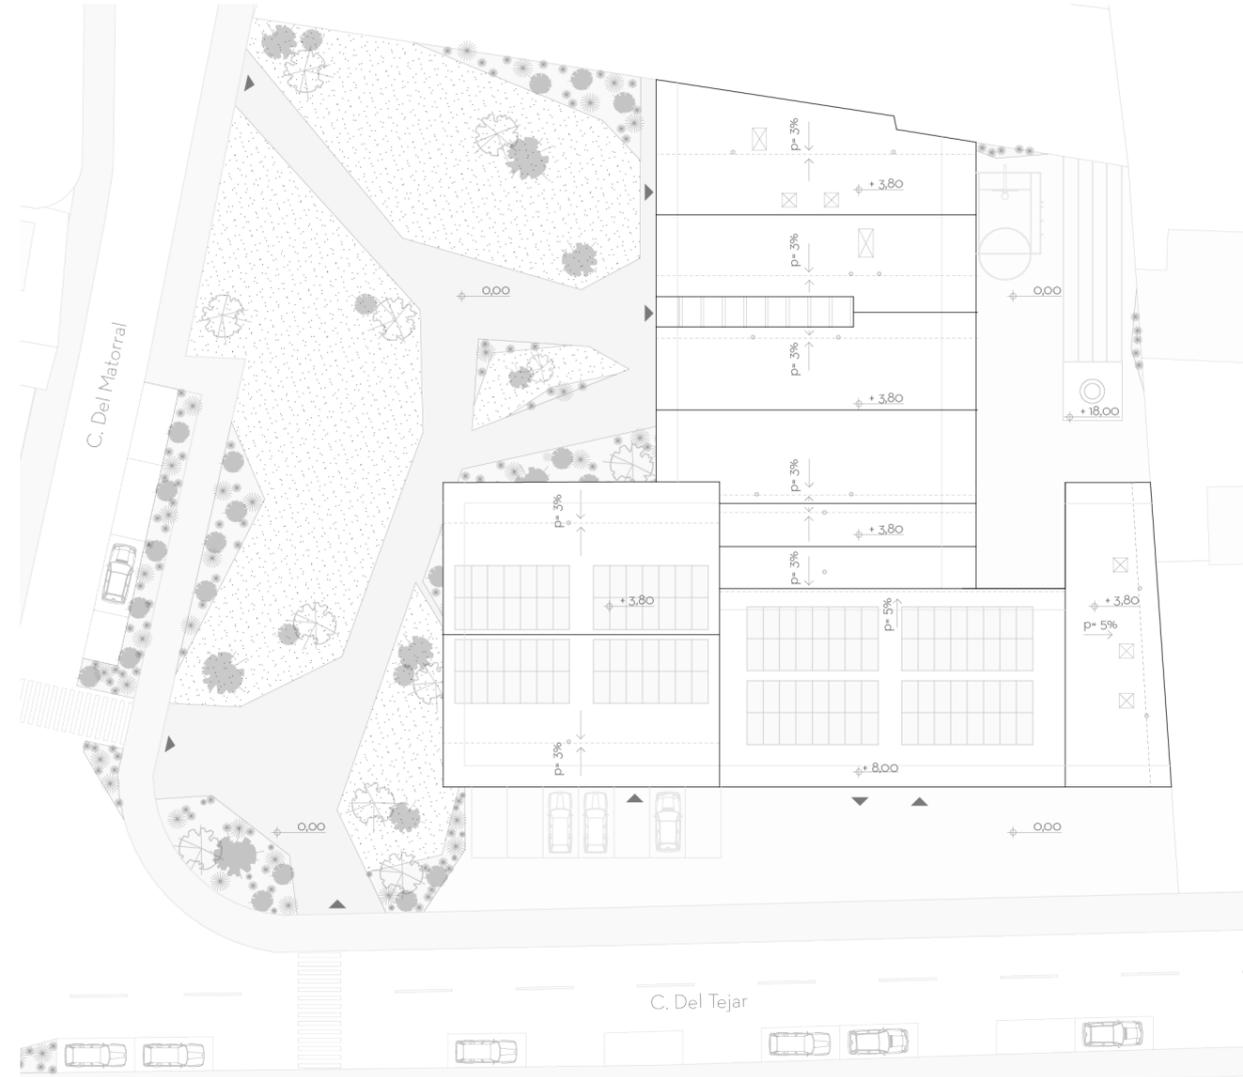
Planta de cubiertas. Fuente: Elaboración propia
